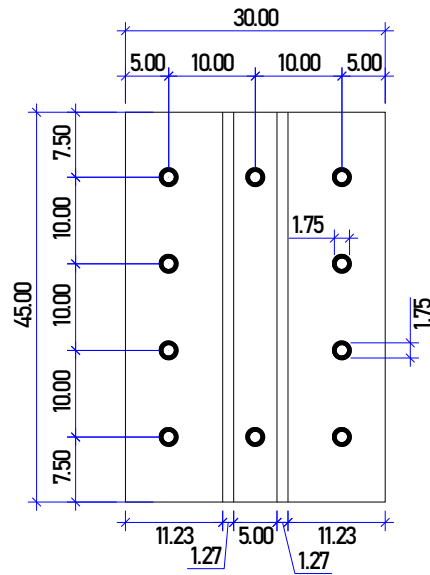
Plancha metálica sobre de la cual irán los pernos de anclaje (Vista en planta)
